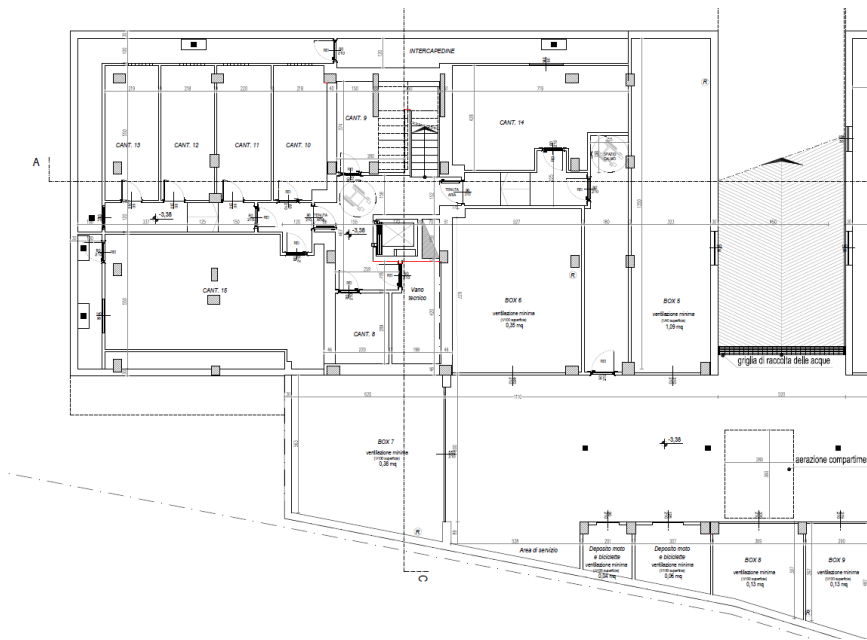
ESTRATTO PLANIMETRIA ALLEGATA A ULTIMO STATO AUTORIZZATO (SCIA)
